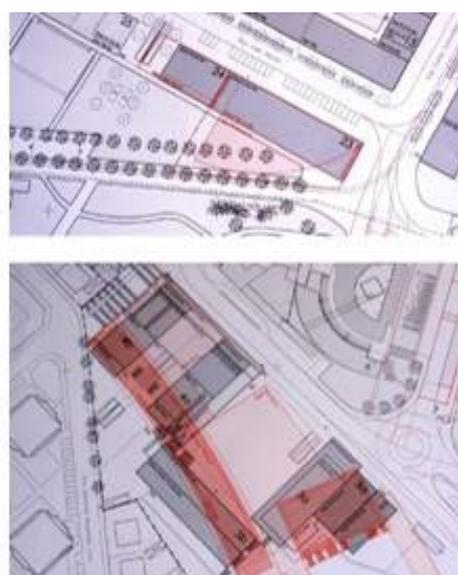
PP Centro publicado em DR a 25 de março de 2011- alterações
